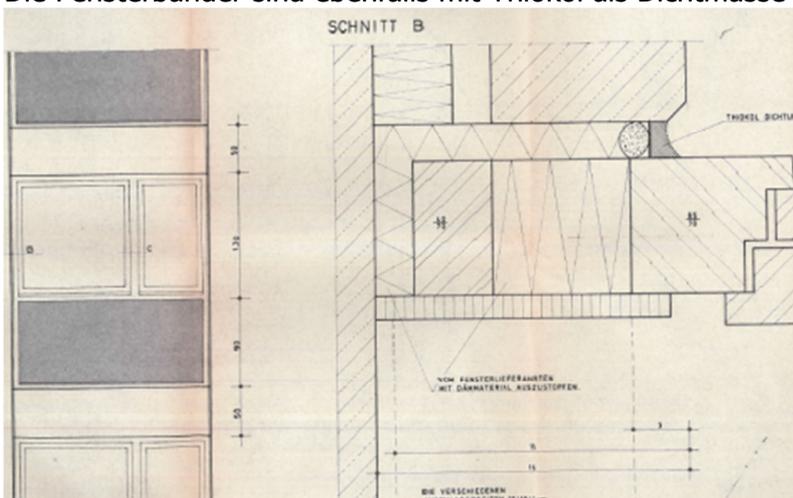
Planauszug, Fensterbänder mit Abdichtung „Thiokol“
